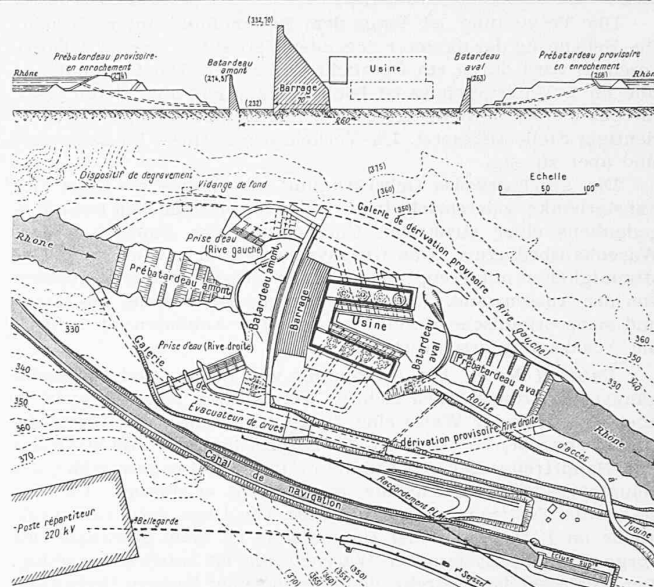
und 2. Grundriss und Längsschnitt des Talsperren-Kraftwerkes Génissiat an der Rhone. — Masstab 1:8000. (Nach «Génie Civil»)
